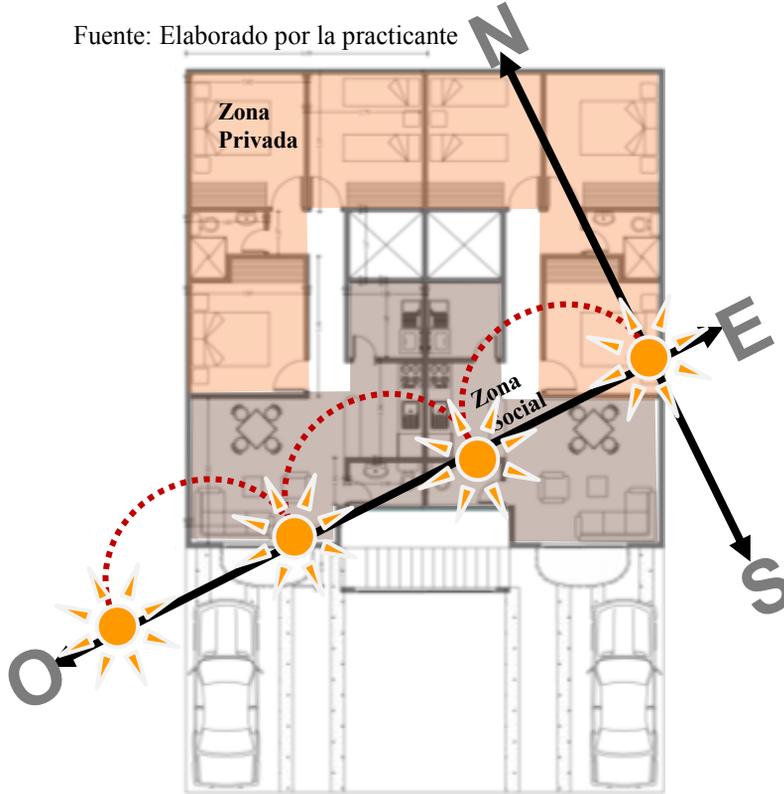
Planta segundo piso del bloque de apartamentos y su asolación
